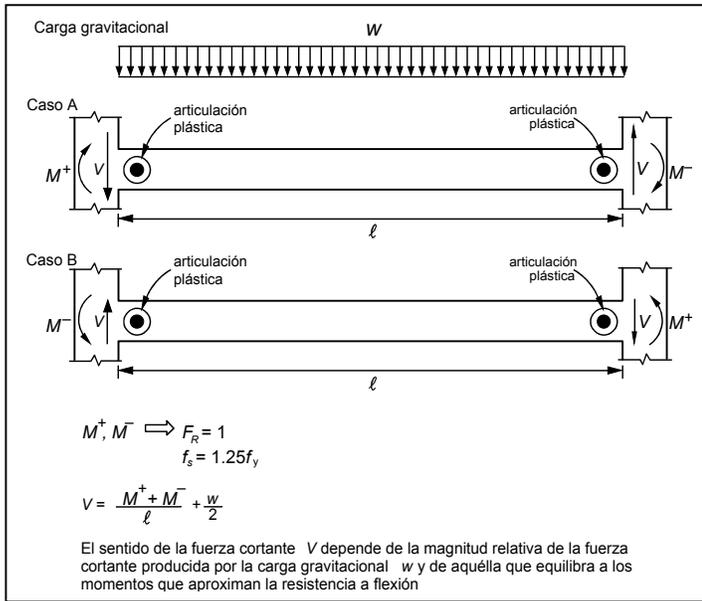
Determinación de la fuerza cortante de diseño en un elemento a flexión.
